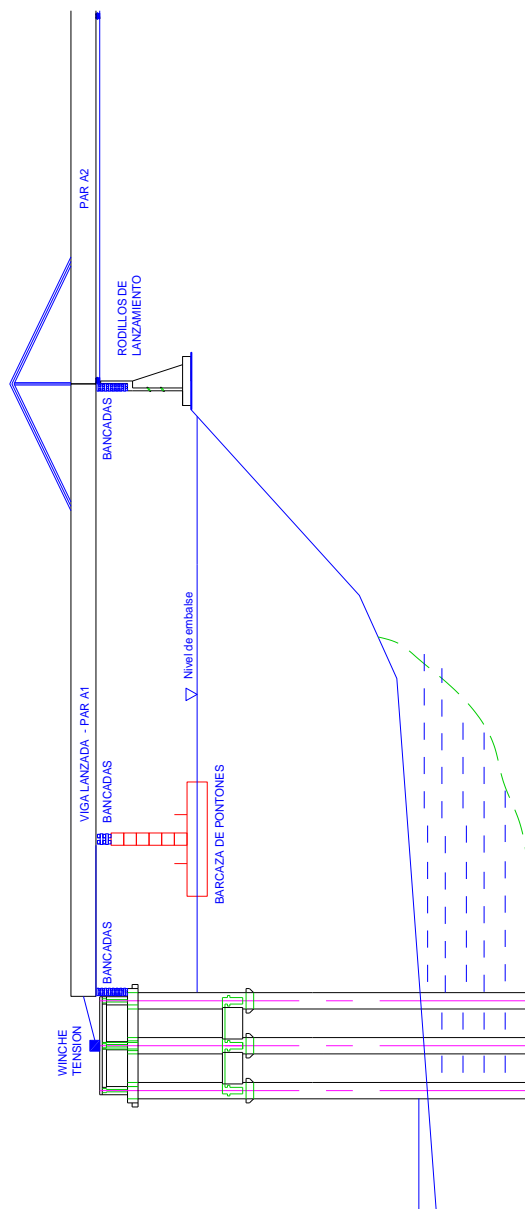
Primer par de vigas metálicas llegan a su posición final y pueden ser descendidas
